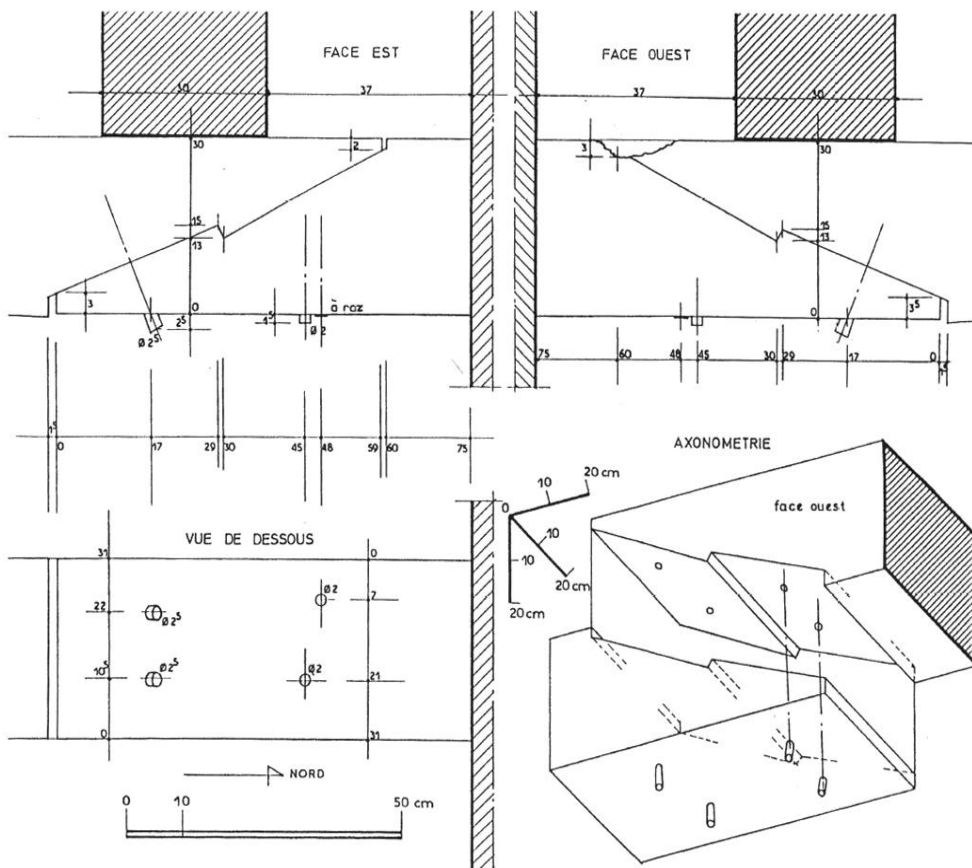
Rez-de-chaussée- Local 6- Cours de poutres- Assemblage. (Dessin H. Rezza Doc. C.R.M.H.)
